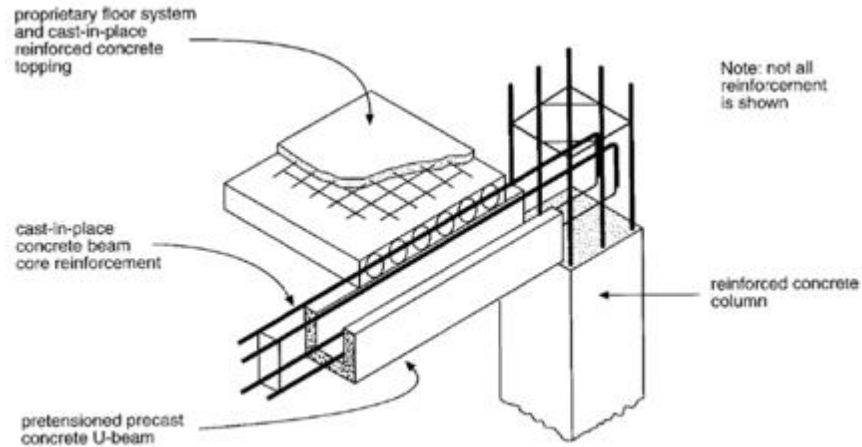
Esquema de la viga y losa prefabricada y el concreto vaciado *in-situ* (fib, 2003).
